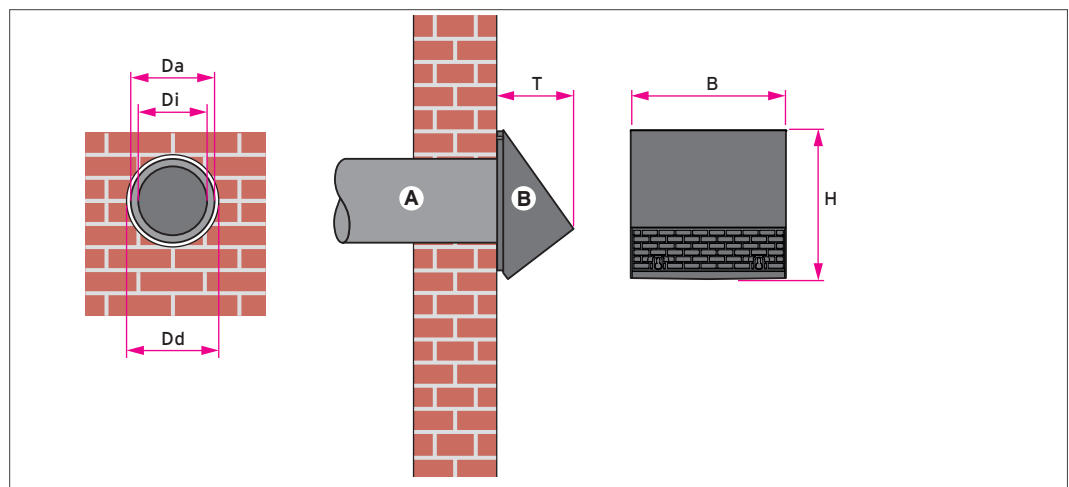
Fassadendurchführung mit dünnwandigem EPP Rohr
